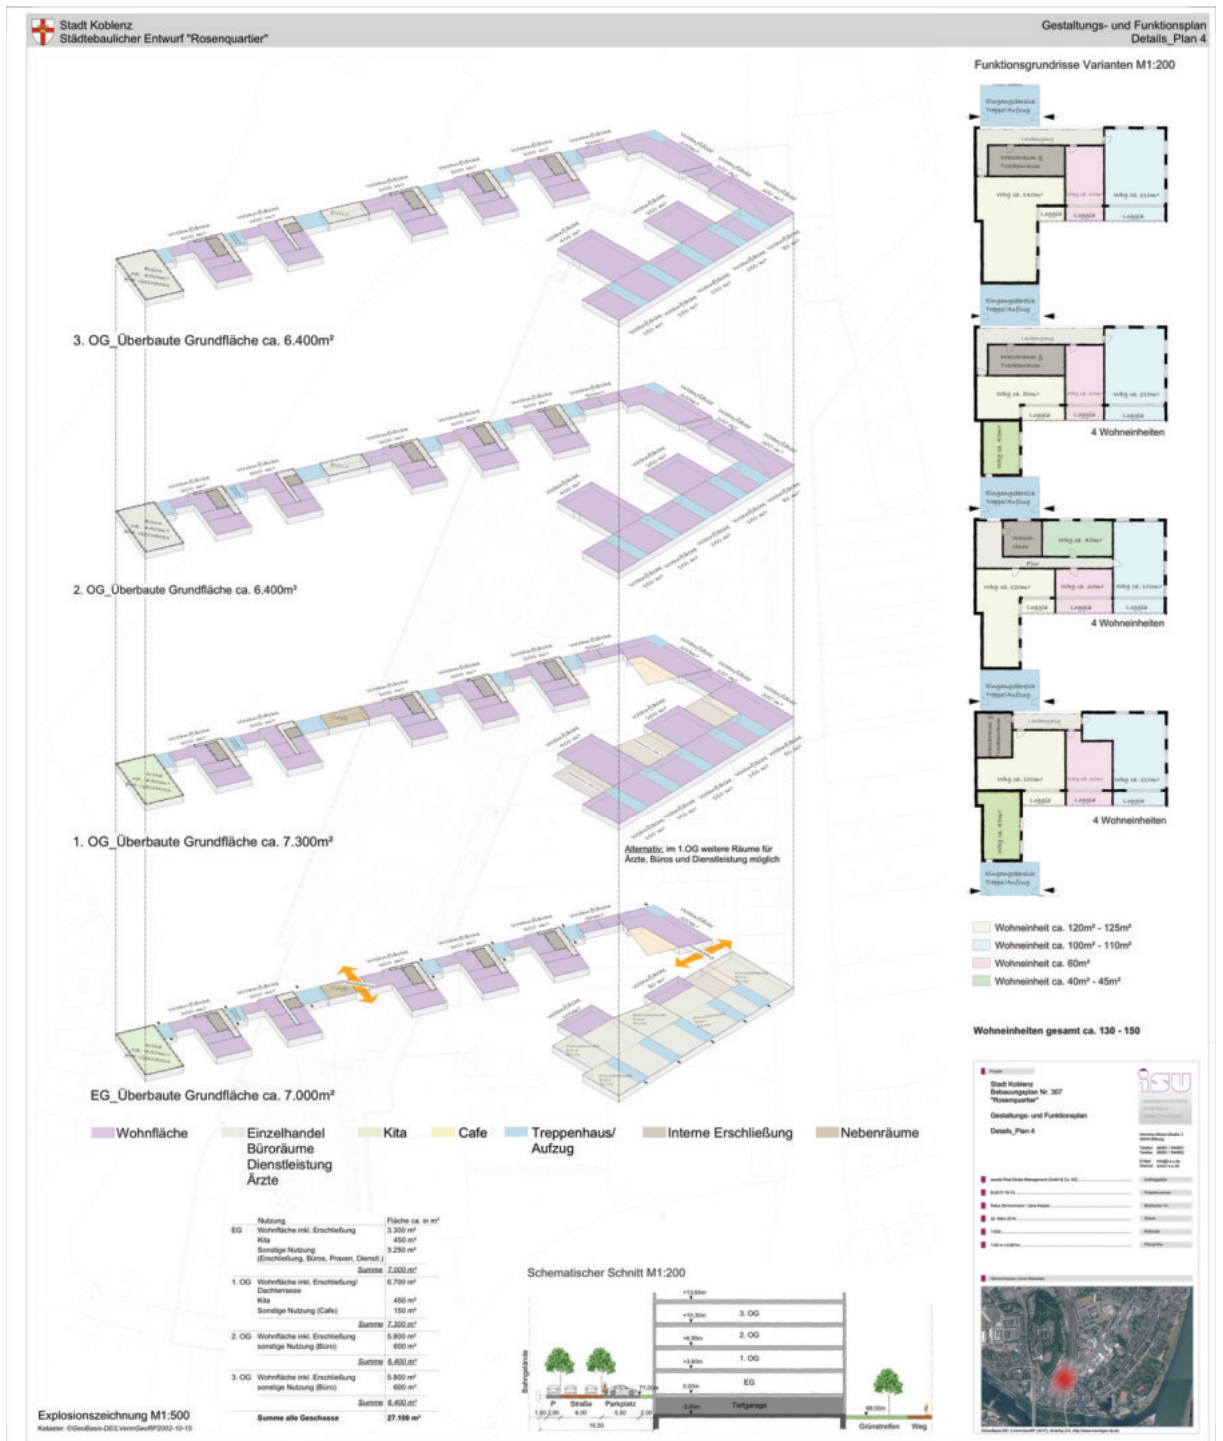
Funktions- und Gestaltungsplan – Plan 4 – Details (Verkleinerung ohne Maßstab) (Quelle: ISU 2018)
